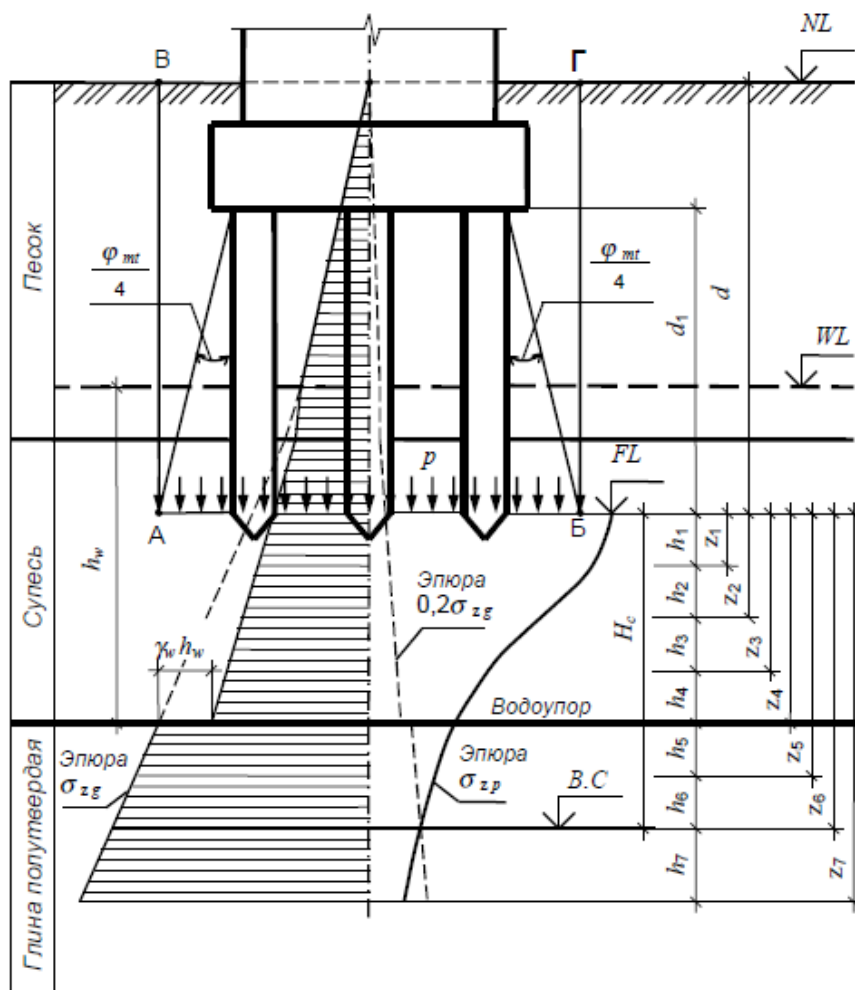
Схема распределения напряжений в основании свайного фундамента
